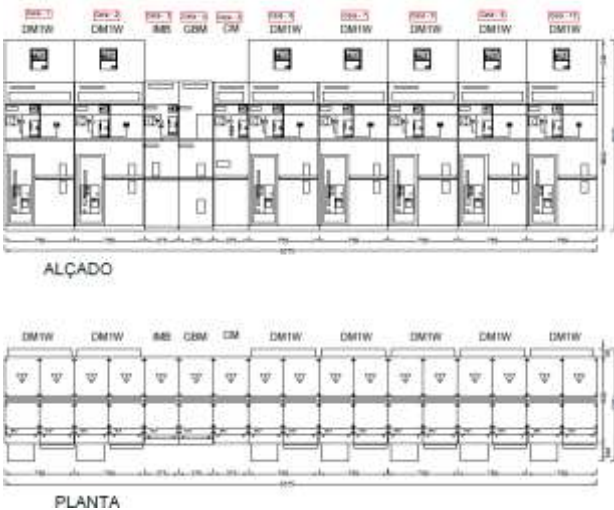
Desenho técnico da disposição das celas de MT [12].
